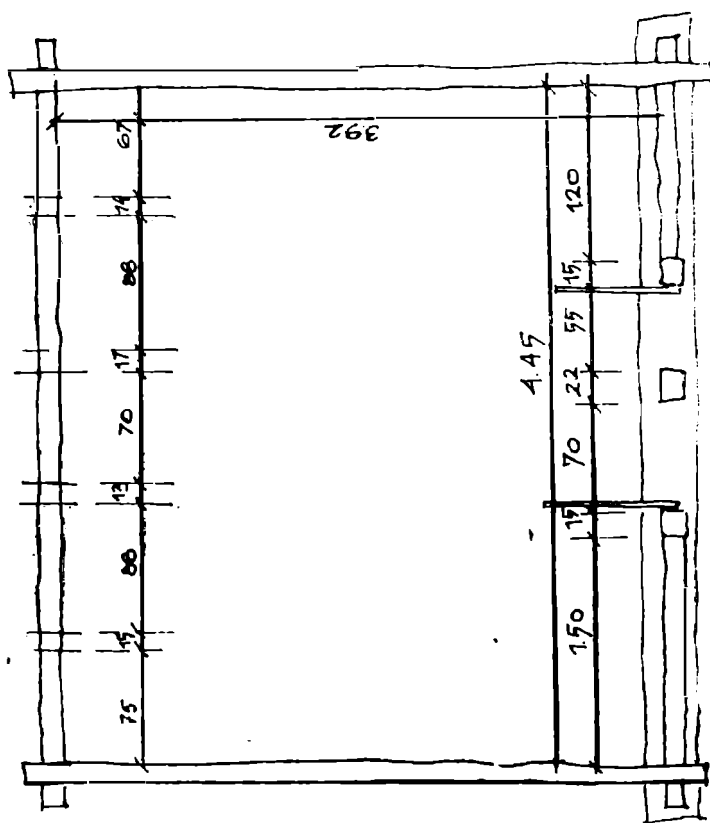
Crama de la Dumbrăveni. Fațadă și plan.
